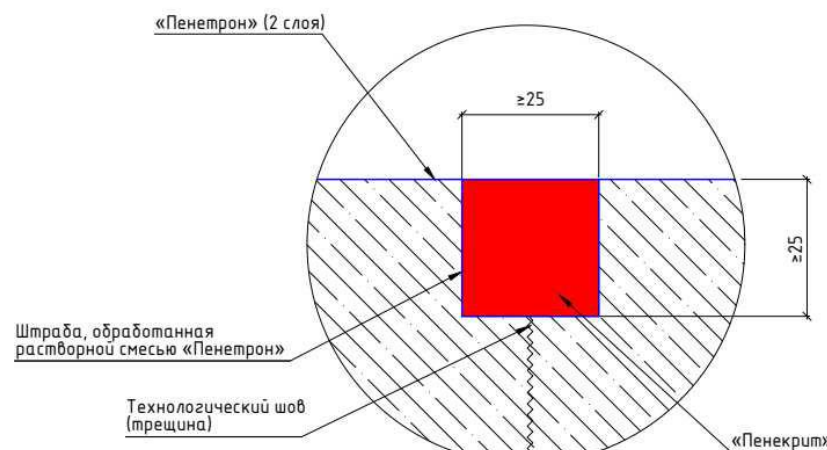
Схема гидроизоляции трещины при
